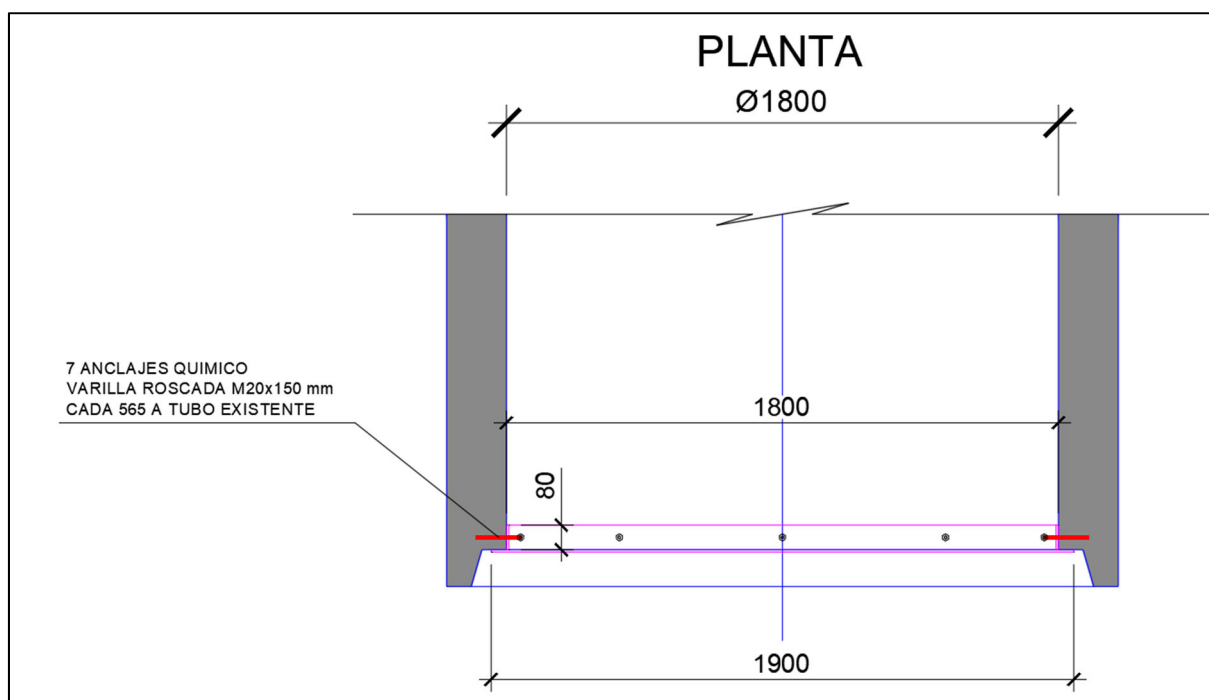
Vista en planta de la instalación de la chapa de acero de reducción de la sección.
